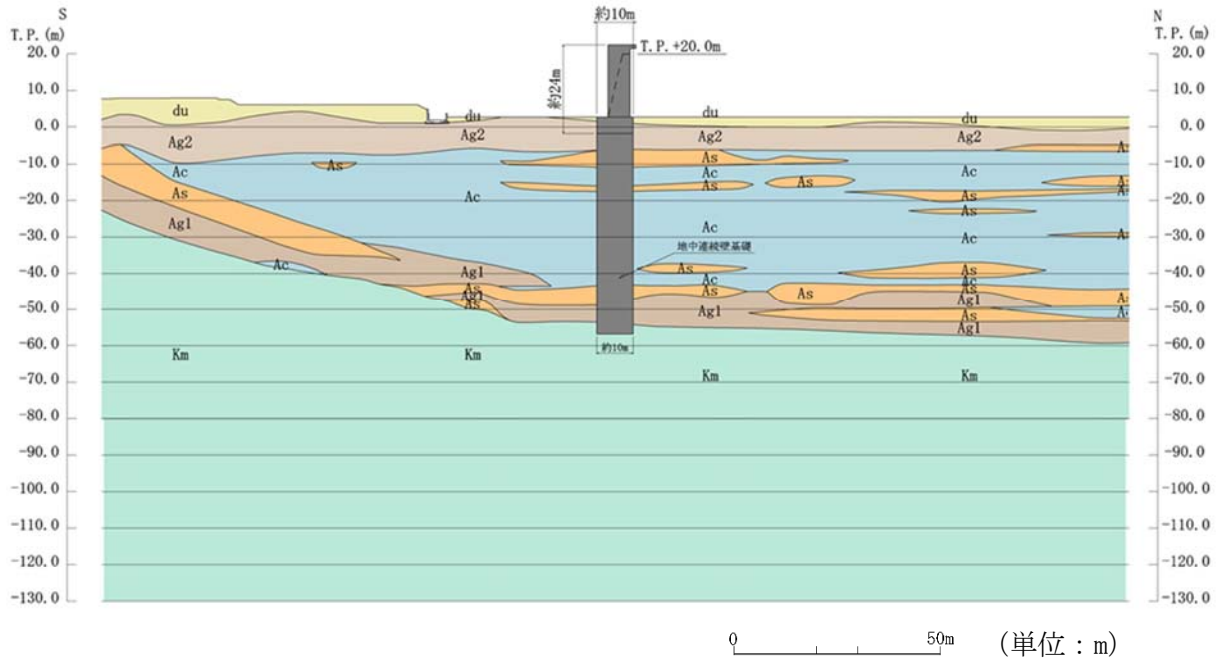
(1) 鉄筋コンクリート防潮壁 評価対象断面図 (①-①断面)
